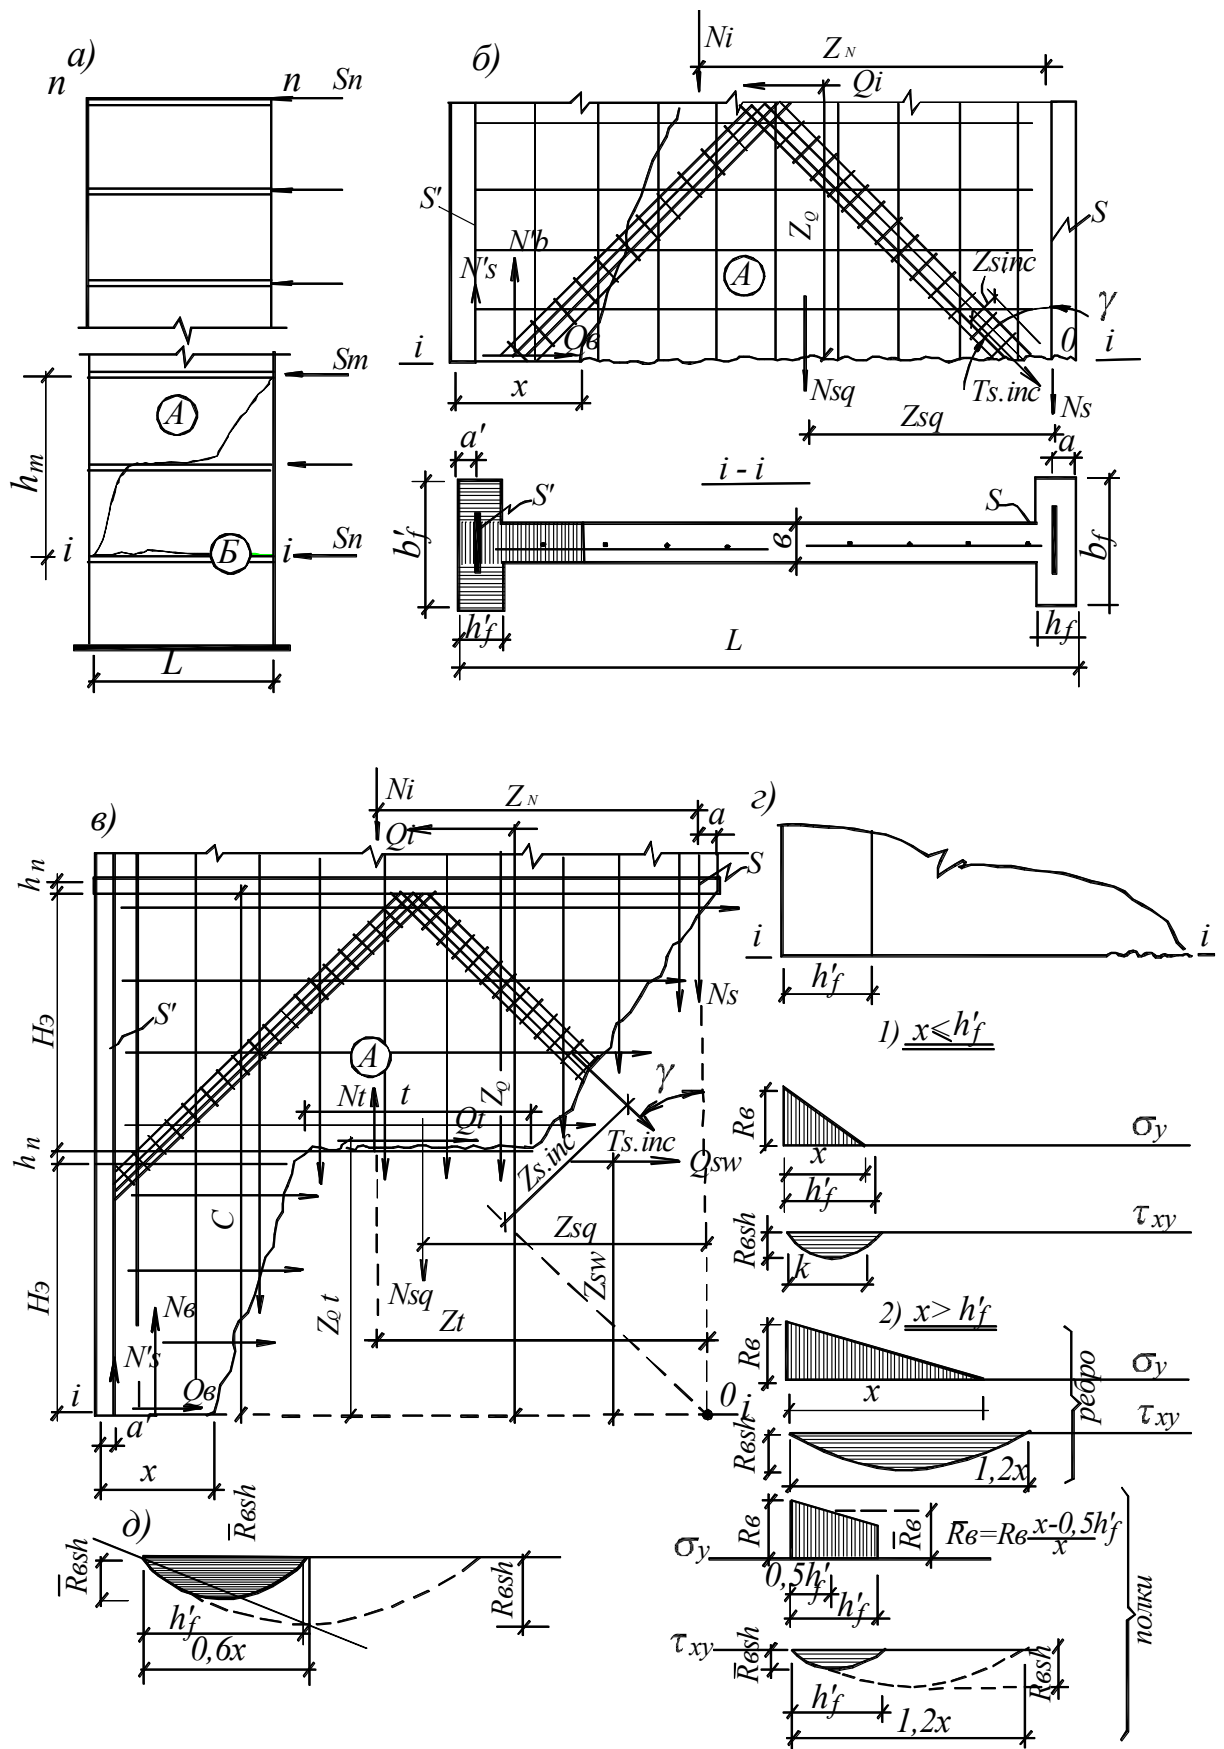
Schema de calcul a rezistenței pereților structurali din beton armat, construiți cu utilizarea elementelor mari de cofraj și/sau cofraj modular-spațial
